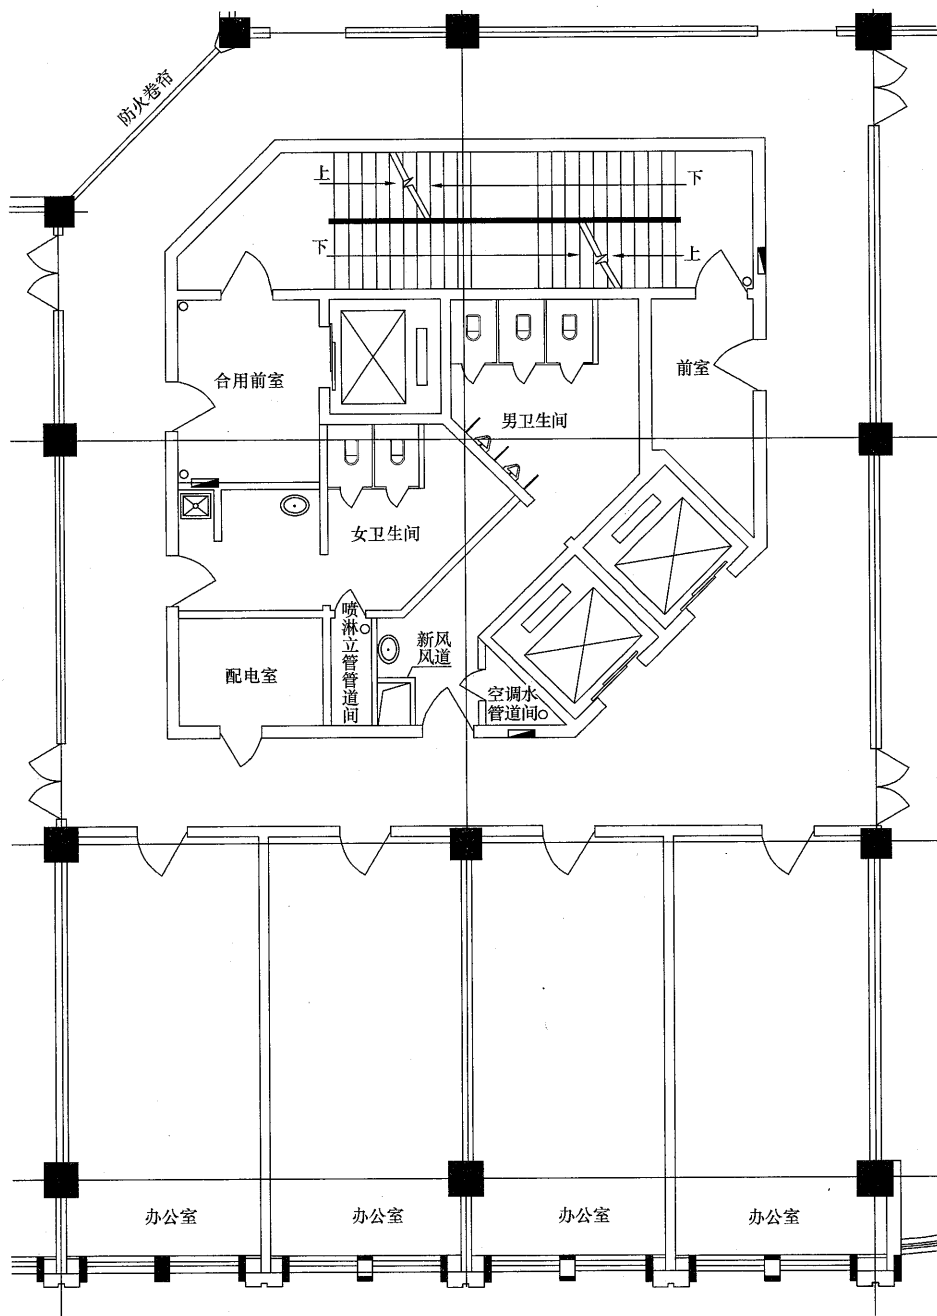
(a) 有环管层消火栓平面图 (参考答案)
